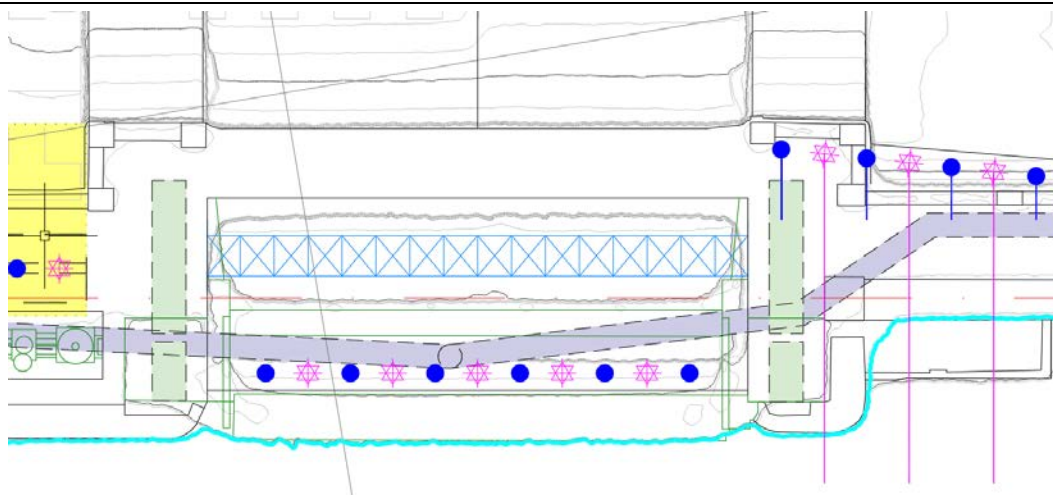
struttura metallica di contrasto sullo sfioratore – pianta (in blu)
